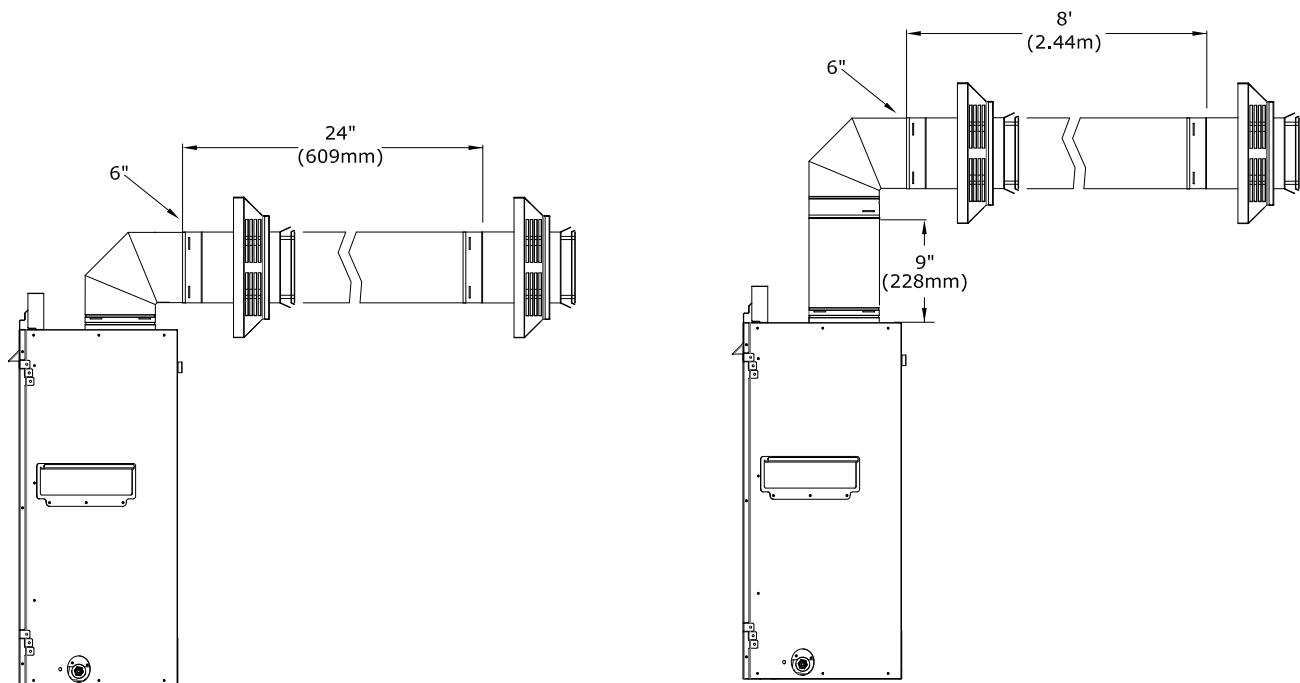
Conduit 4"x6-5/8" à terminaison horizontale
